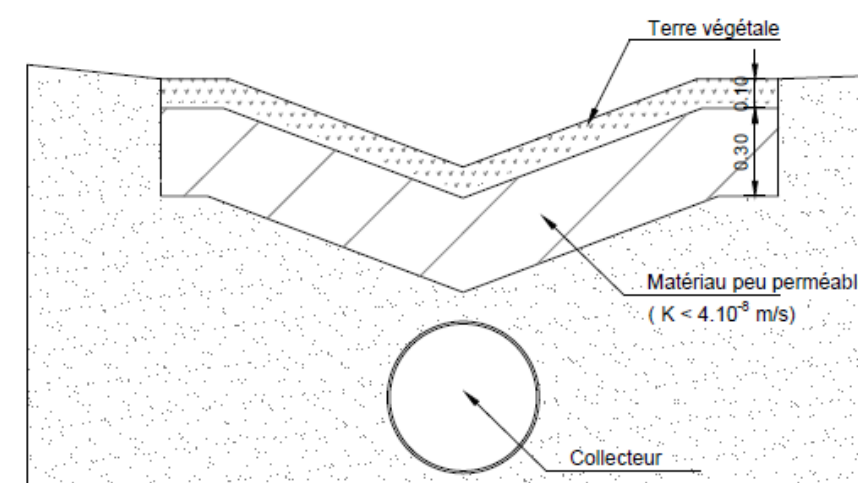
Coupe du dispositif de collecte noue et collecteur (Source : setec, octobre 2016)
